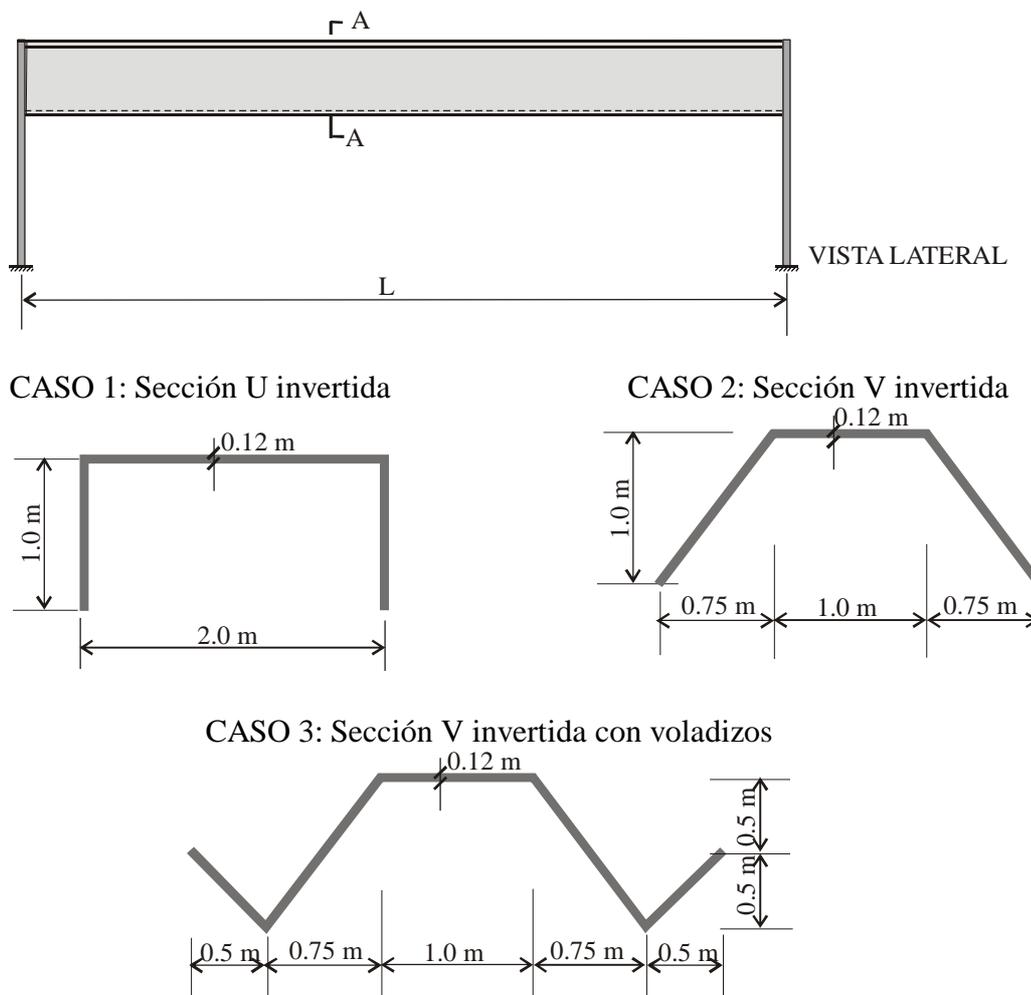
Diferentes secciones transversales para una estructura plegada apoyada en vigas extremas
